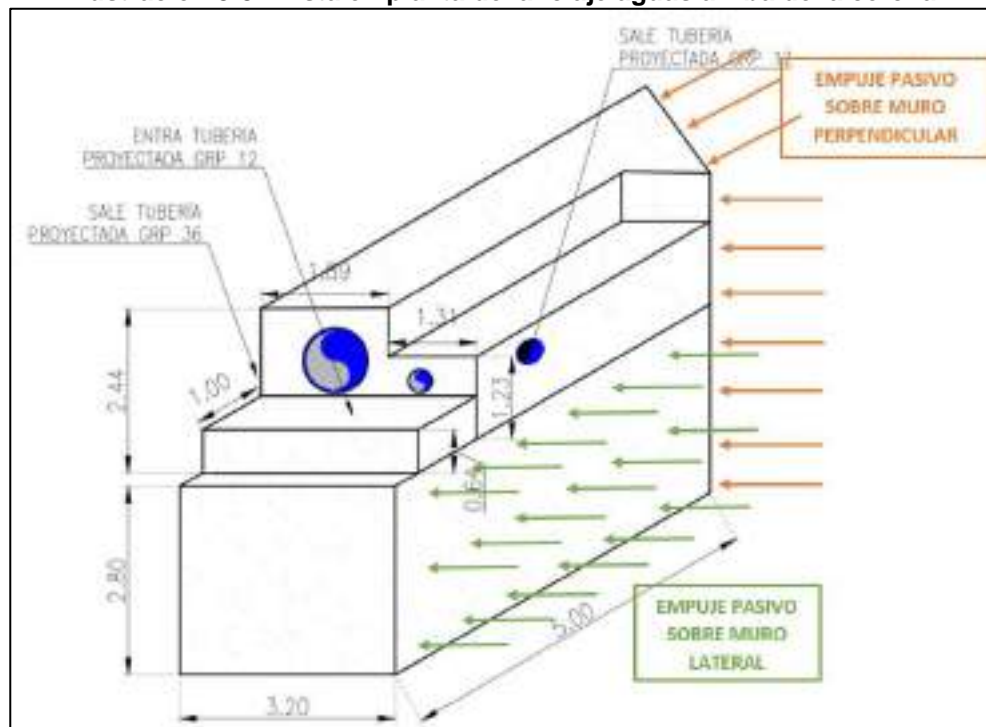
Vista en planta del anclaje aguas abajo de la cercha
